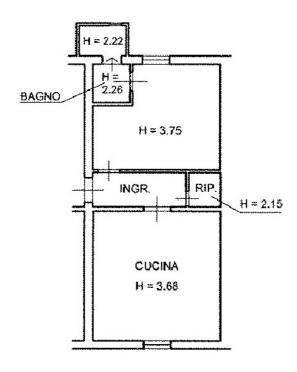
Planimetria dell'appartamento al piano primo (sub 14)
